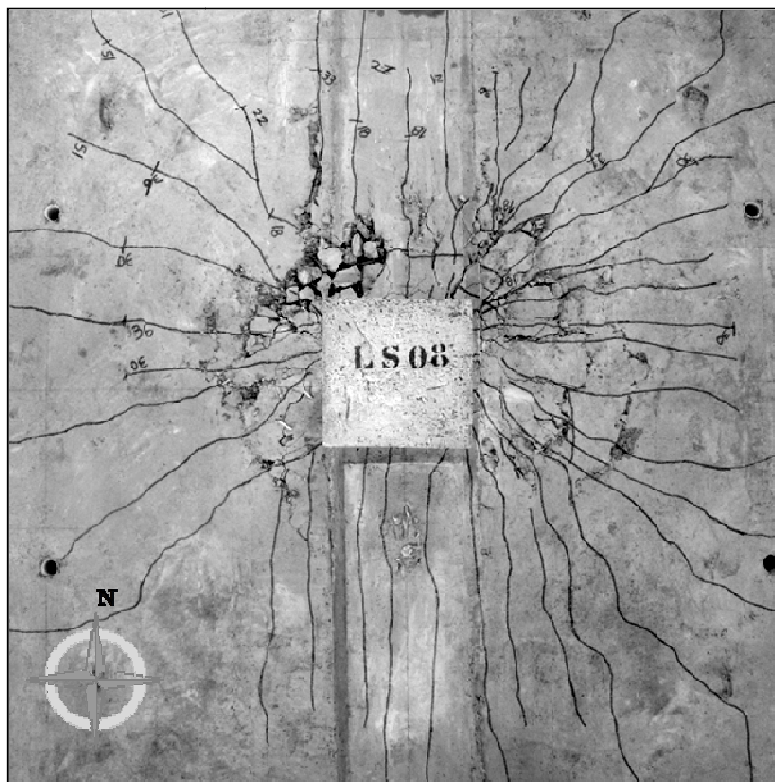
Mapa de fissuração da laje LS08
